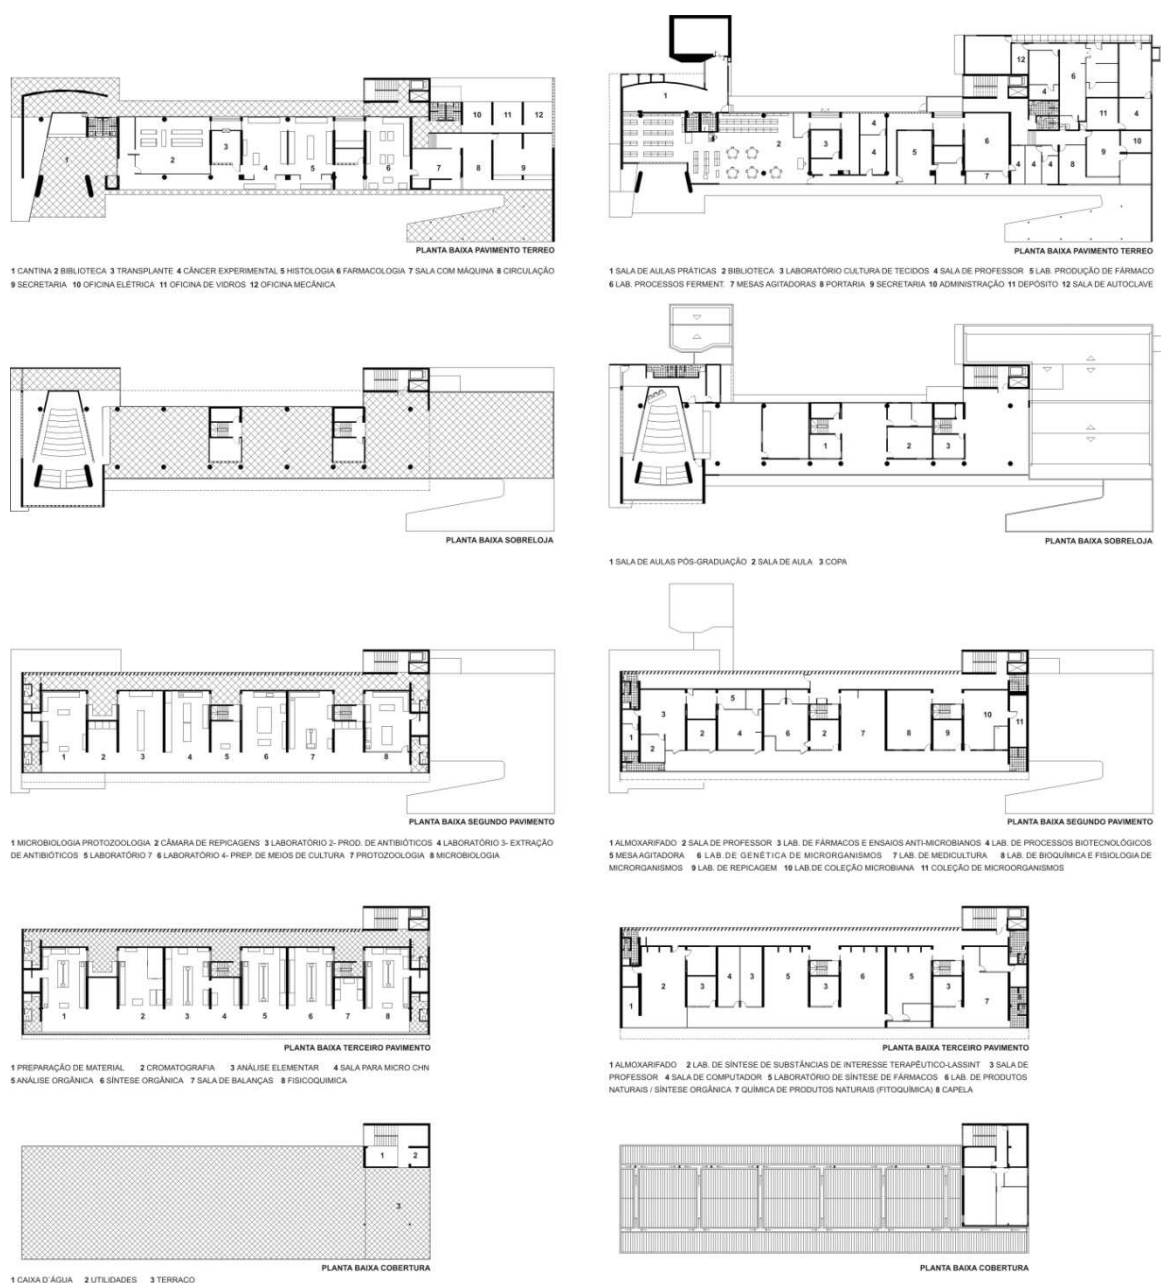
Plantas do projeto executado (1953) e levantamento da situação do imóvel (2007). Fonte: Prefeitura da Cidade Universitária, UFPE.
